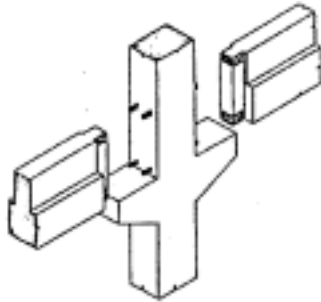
Sambungan Basah (In –Situ Concrete Joint)
